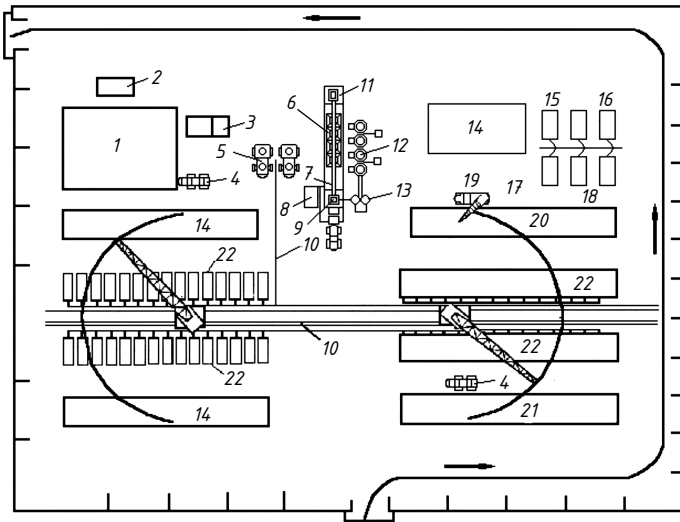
Генеральный план полигона по изготовлению железобетонных изделий:
